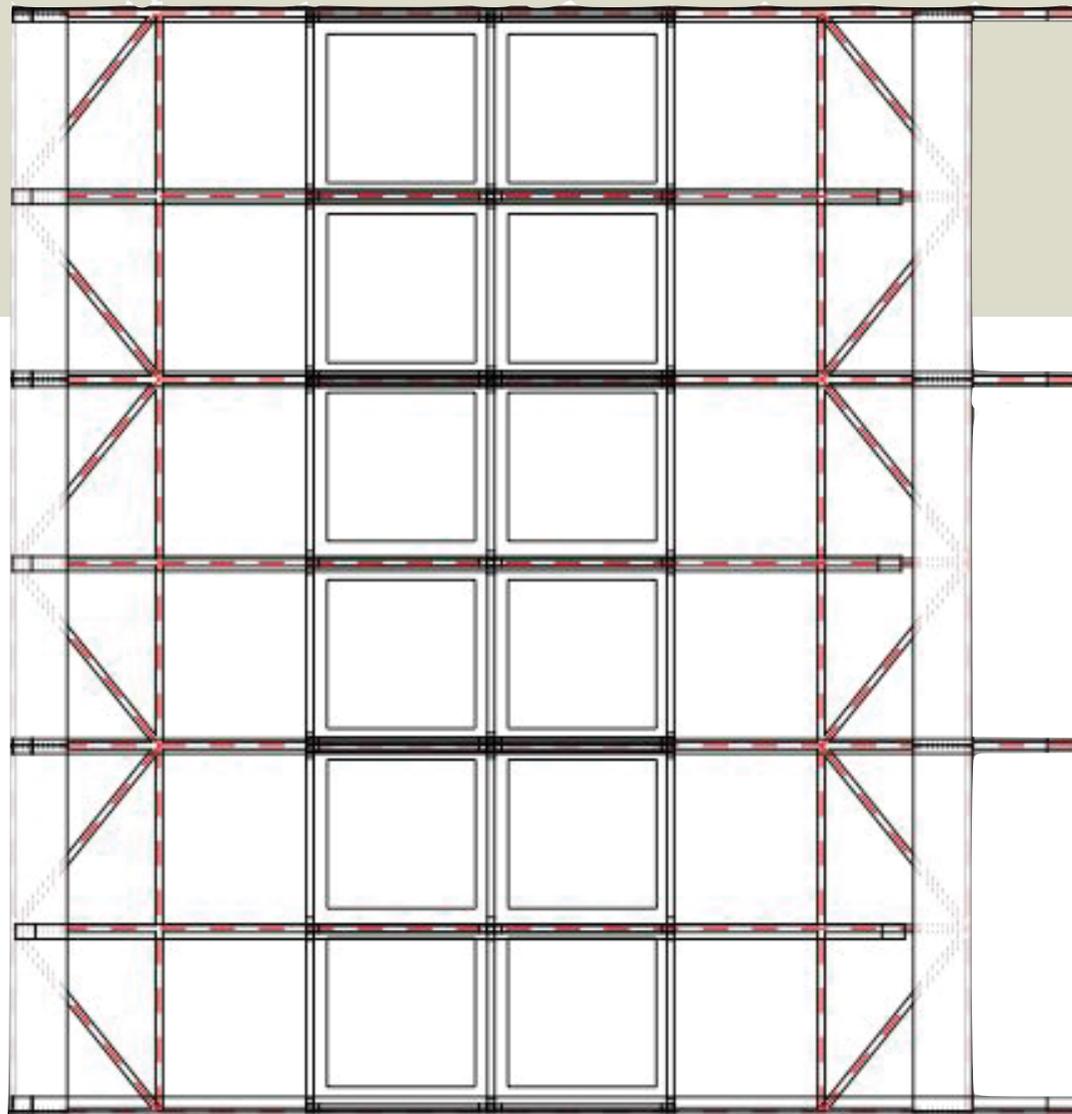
Planta Estructura Obra Viva Modelo Dos. Fuente: Miguel Oviedo.
